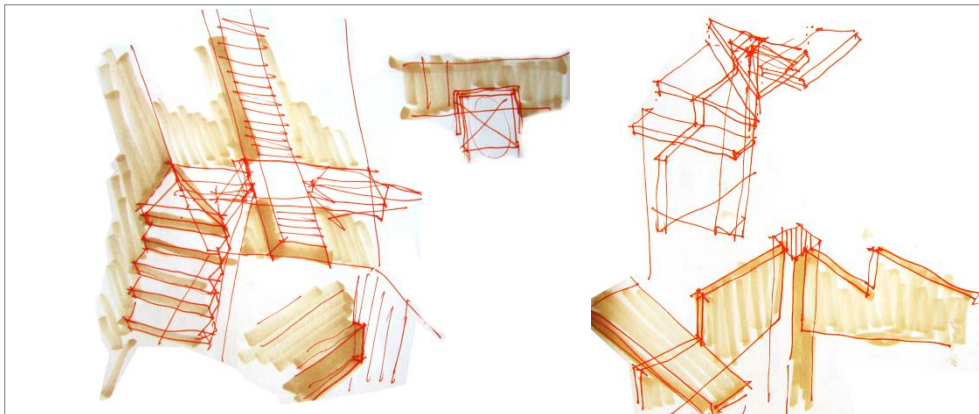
| ESCADAS EM ESTRUTURA DE MADEIRA. PORMENORES CONSTRUTIVOS - TORRE SINEIRA
